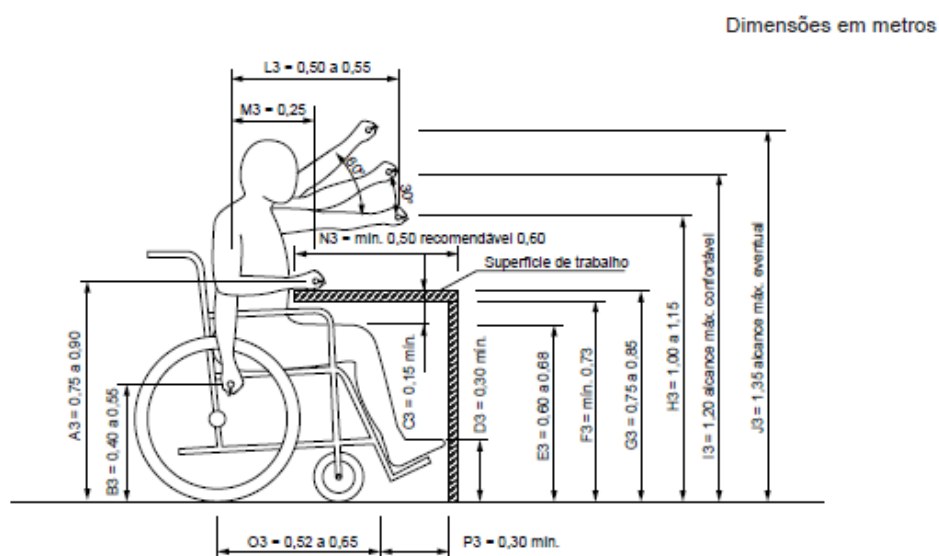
Dimensões referenciais para alcance manual frontal com superfície de trabalho, para pessoa com cadeira de rodas
